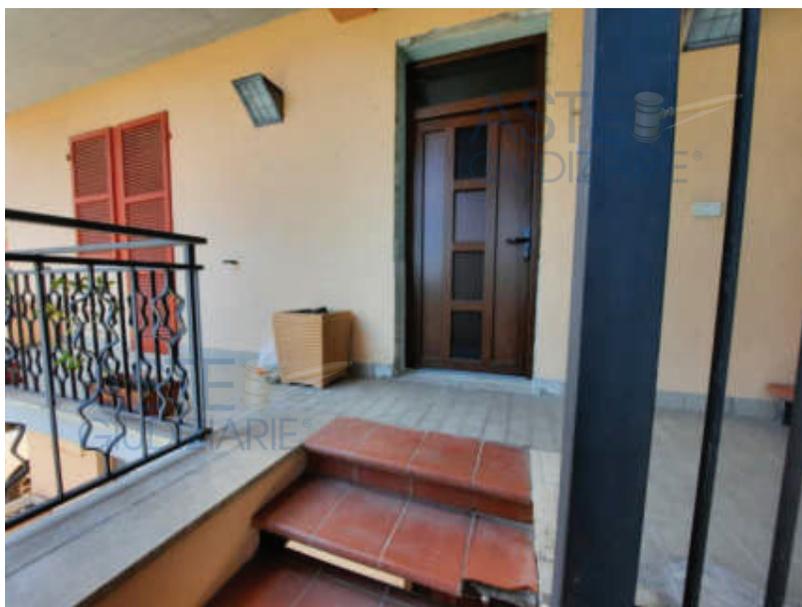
sub 8 Ingresso al piano primo dalla scala esterna
